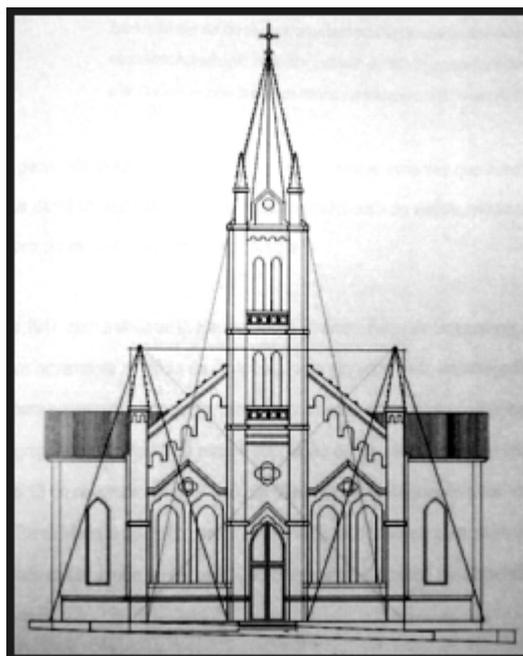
Fachadas com formas em triângulo – Desenho do Arquiteto José Carlos Schirmer
